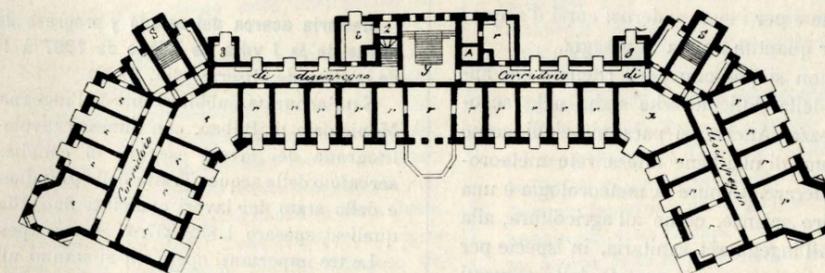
SANATORIO-HOTEL - Pianta del piano superiore.
